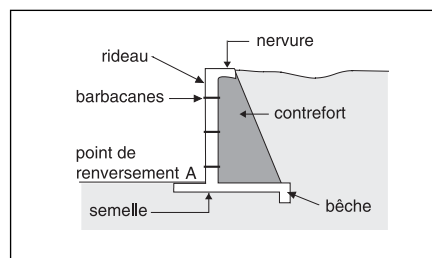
Configuration classique des murs de soutènement en béton armé. Barbacane, élément placé tous les 2 à 3 m² pour éviter l'accumulation d'eau (laquelle augmente la charge de poussée). Bèche, ancrage s'opposant au glissement provoqué par la poussée des terres. Contrefort, élément assurant la rigidité de l'ensemble et fournissant un ancrage latéral. Semelle, fondation pouvant déborder en avant du rideau pour assurer une meilleure répartition des pressions sur le sol.
